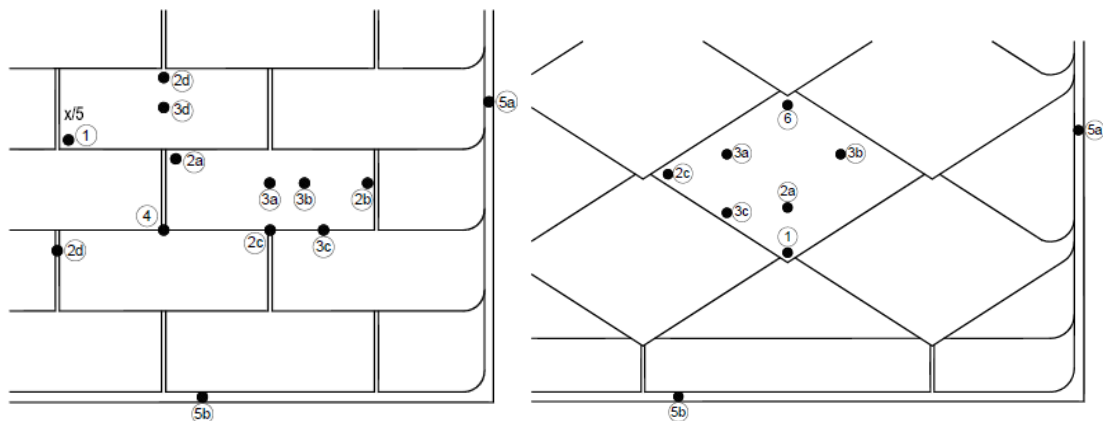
Beschussorte für ebene Faserzementelemente ($x/5$ = Projektdurchmesser)
